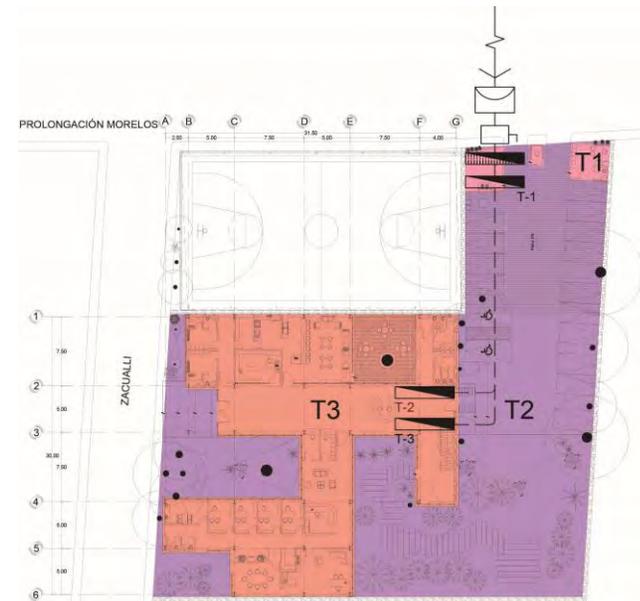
Zonificación por tableros. Planta baja, tableros: T1, T2 y T3.
